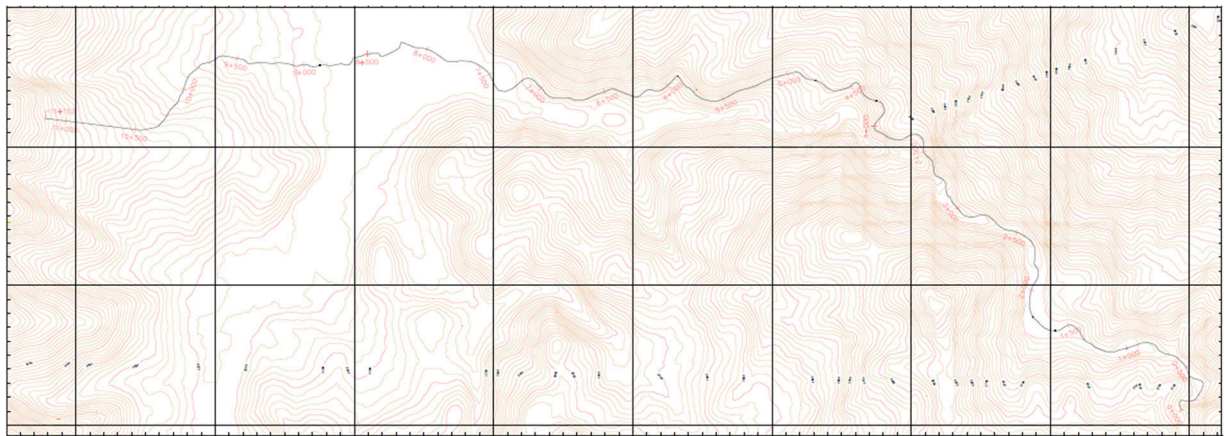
Vista en planta de levantamiento topográfico de la línea de conducción
